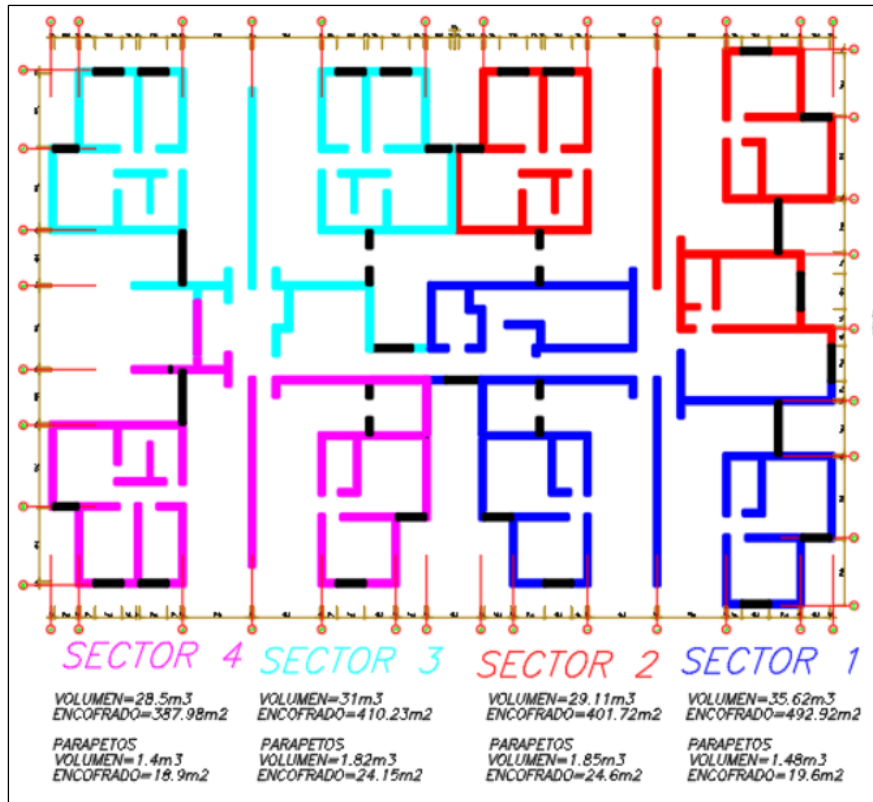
Sectorización – Metrados de Encofrado, Concreto - Placas
